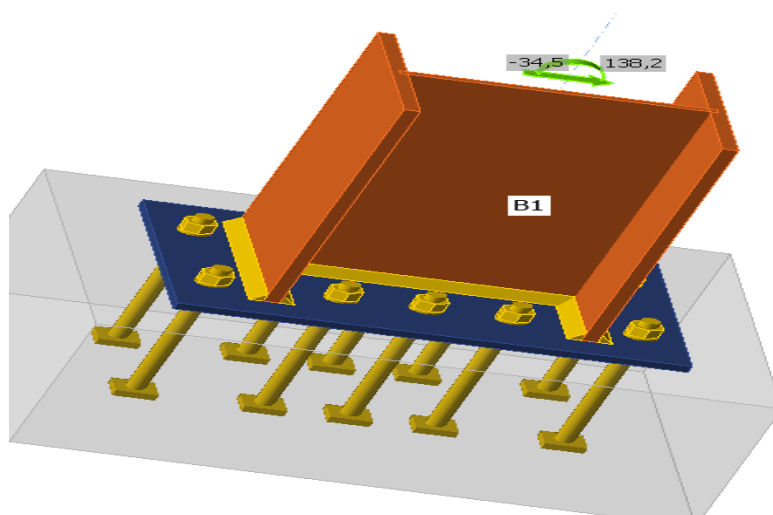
Vue d'assemblage poutre secondaire HEA400 et voile
